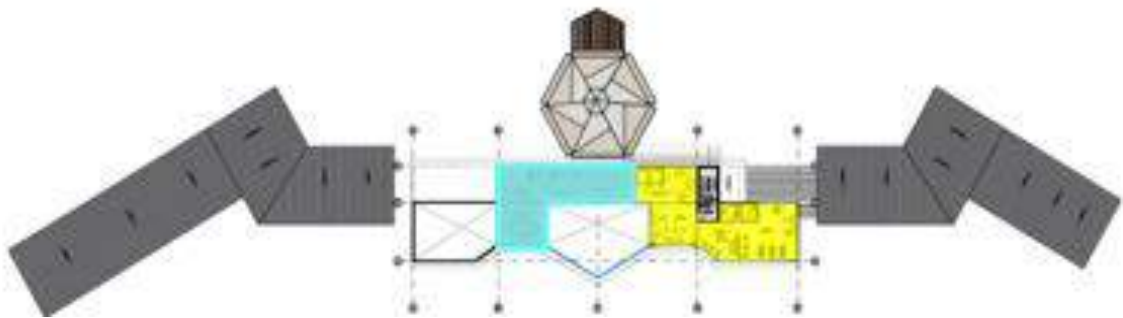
Zonificación Segunda Planta (N.P.T: +33.50m)
